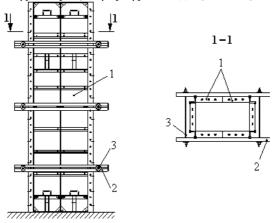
Опалубка прямоугольных колонн широкого сечения: 1 – щит; 2 – выравнивающая балка; 3 – винтовой тяж
